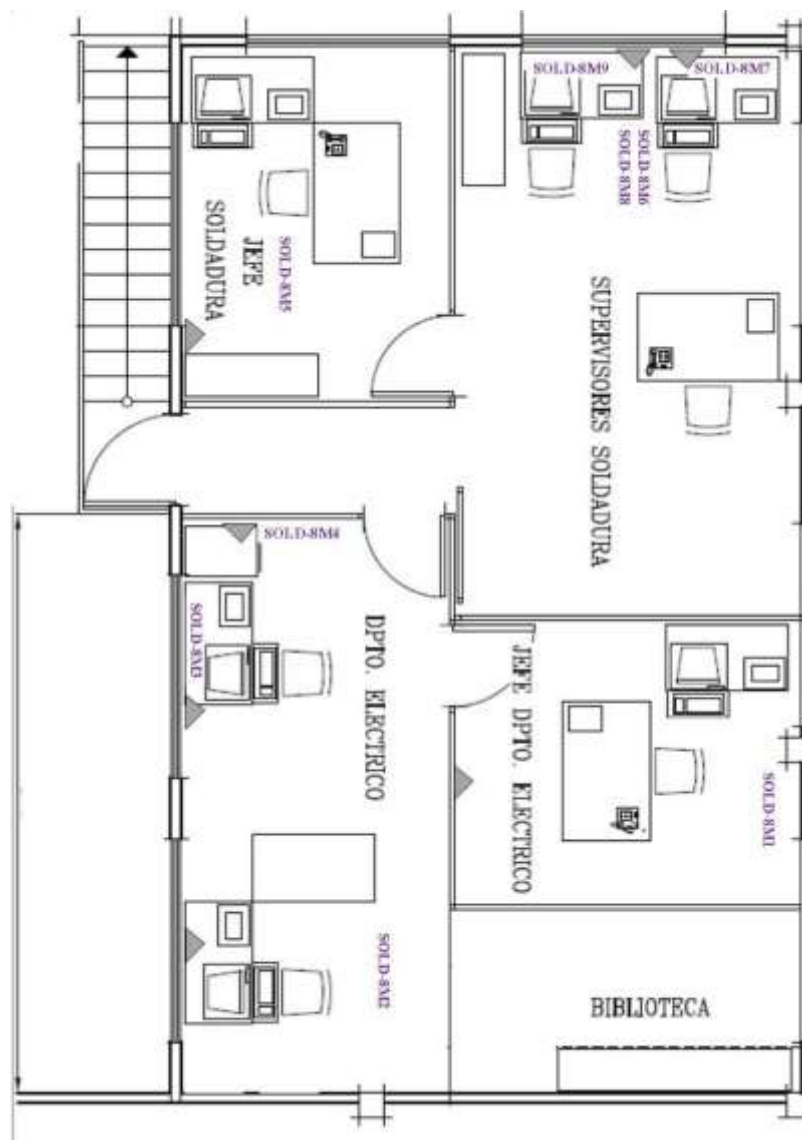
Bodega Mantenimiento y Soldadura - Rack Soldadura
